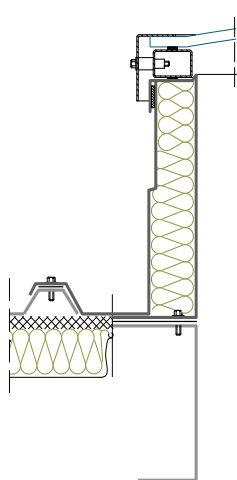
Przekrój podłużny przez kłapę mcr PROLIGHT typ E z podstawą PR do dachów profilowanych wzdłuż spadku dachu
